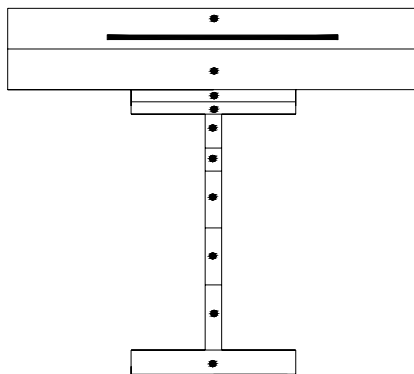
Suddivisione della sezione retta in 12 fibre.
